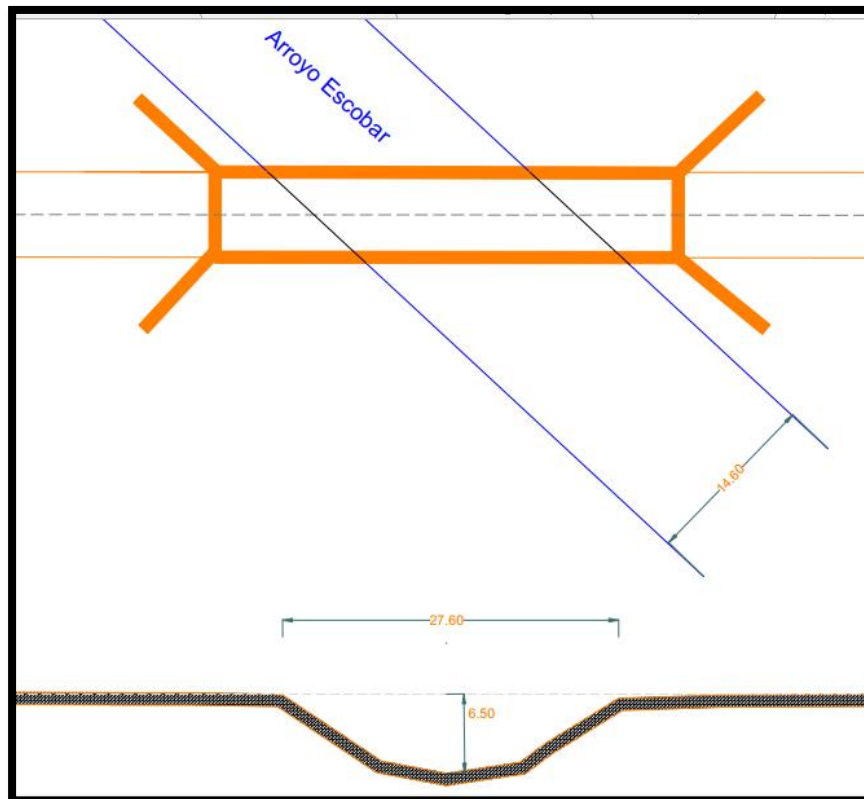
Croquis medidas del arroyo. Fuente: Elaboración propia
